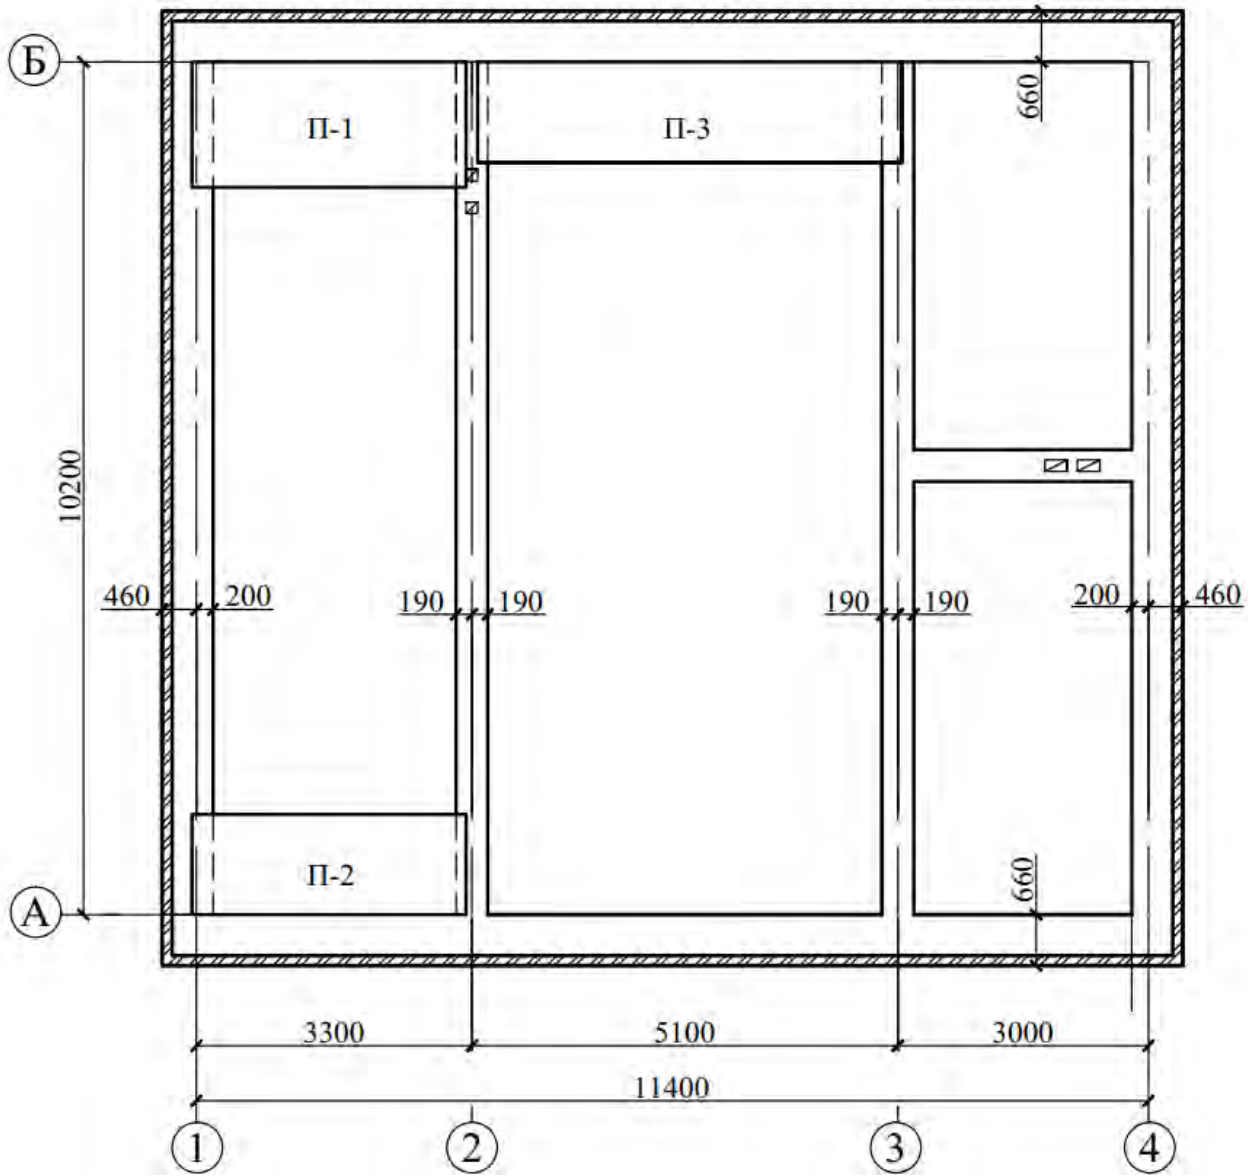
Пример выполнения конструктивной схемы здания с поперечными несущими стенами
